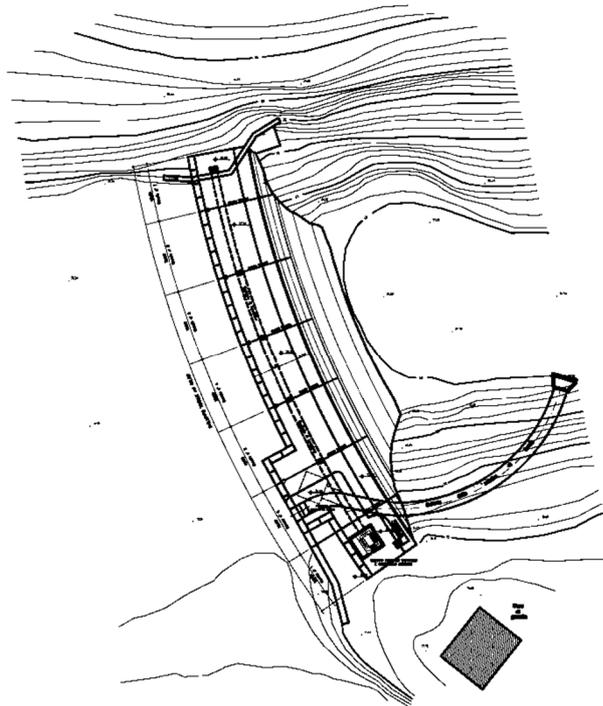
Schema degli interventi in progetto – Planimetria
